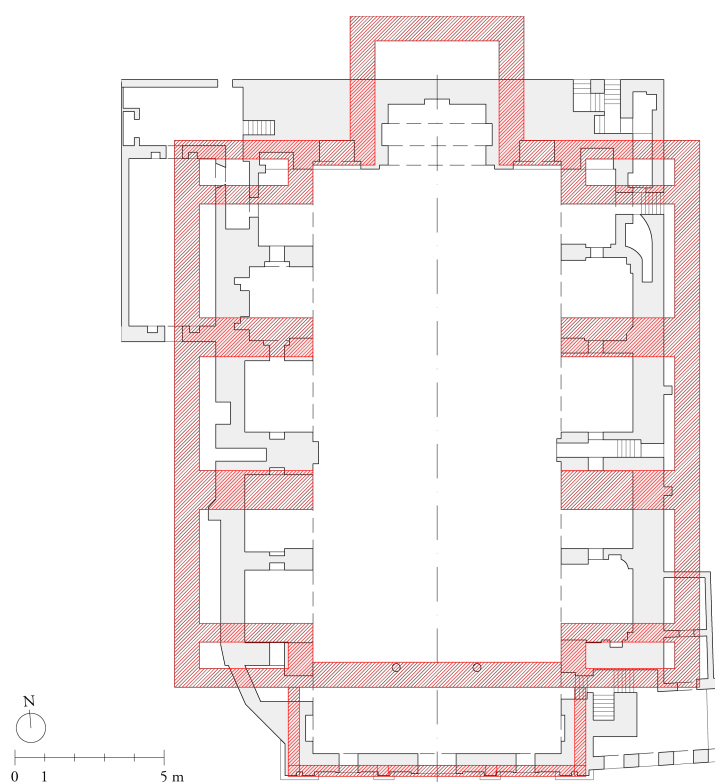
Sobreposição da atual planta da igreja de São Roque, com planta gerada pela GF<sub>AE</sub> (a vermelho).
